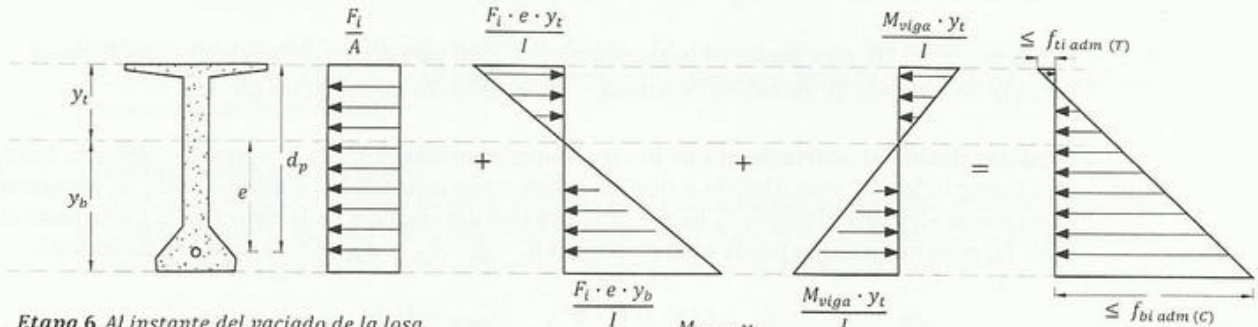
Proceso constructivo de vigas pre y post tensadas
